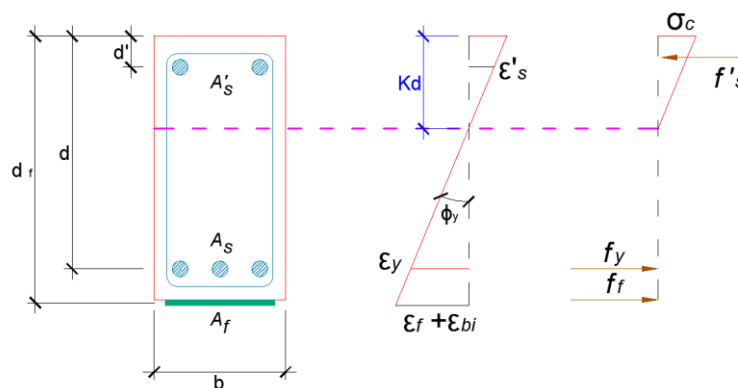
Viga de concreto armado externamente reforzada en el límite elástico por flexión, correspondiente a una viga del modo de Falla A, B y C.
